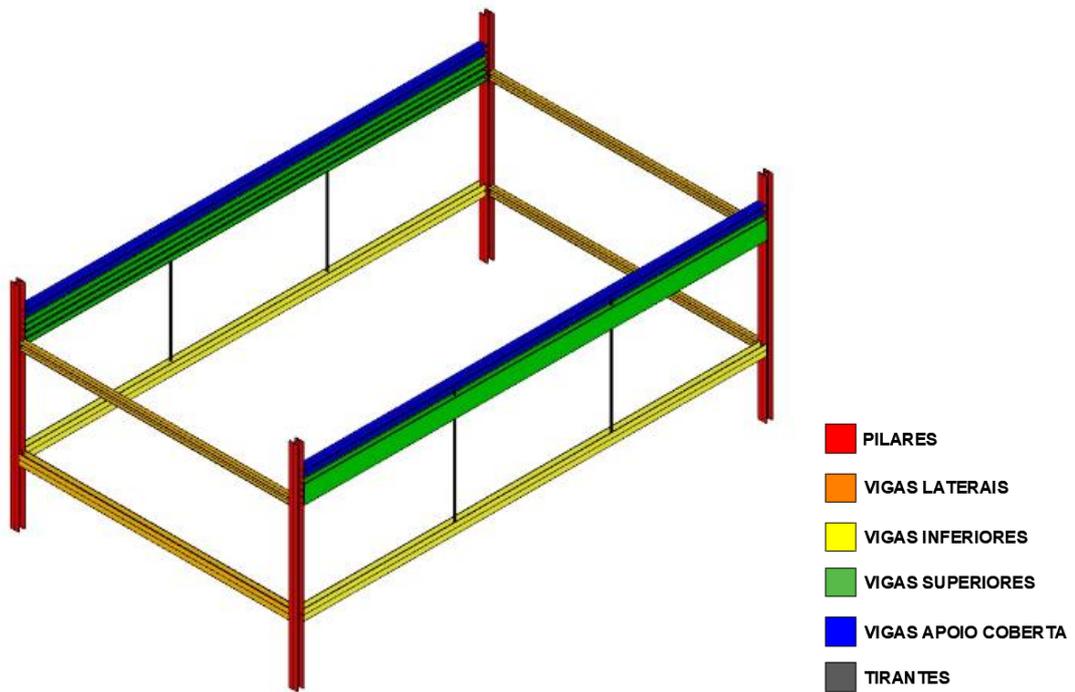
Estrutura metálica existente dentro das empenas com a disposição do Steel frame
